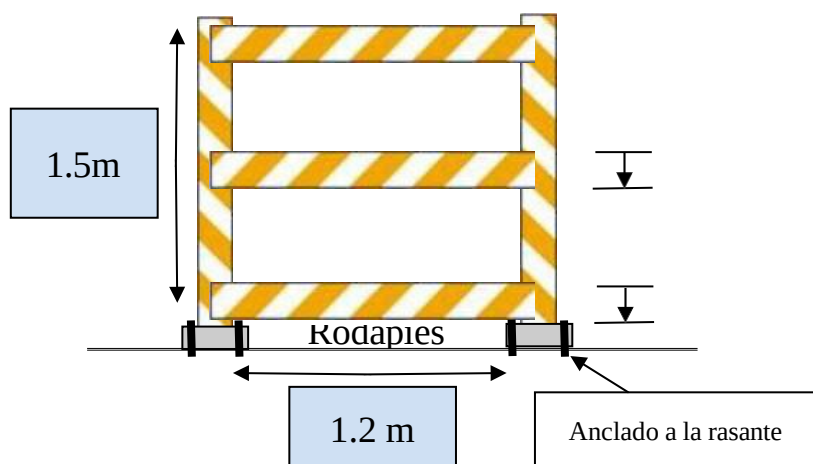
Cerco rígido metálico anclado a la rasante con pernos expansivos a la excavación abierta que permanecen más de 24 horas
